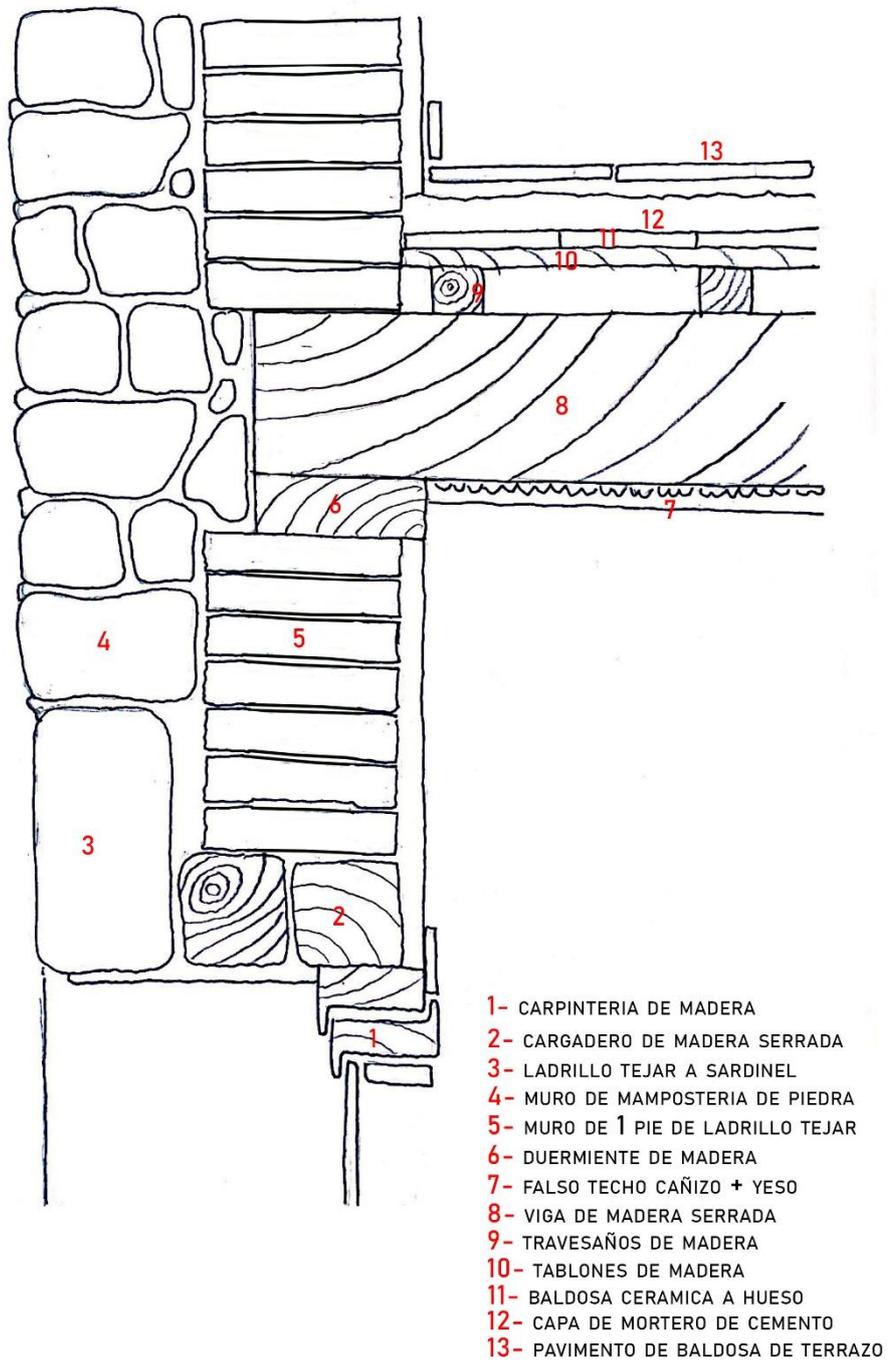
Detalle constructivo original – Huevo superior – Encuentro forjado con muro de fachada
